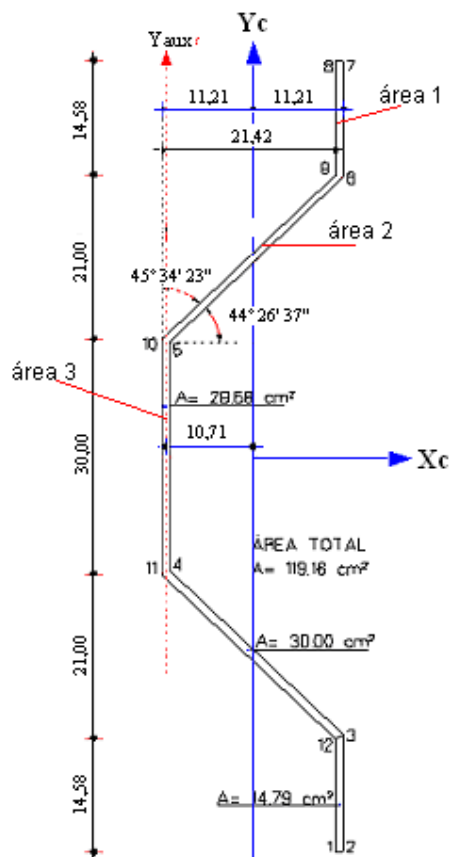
Seção transversal da parede metálica em conformação trapezoidal
